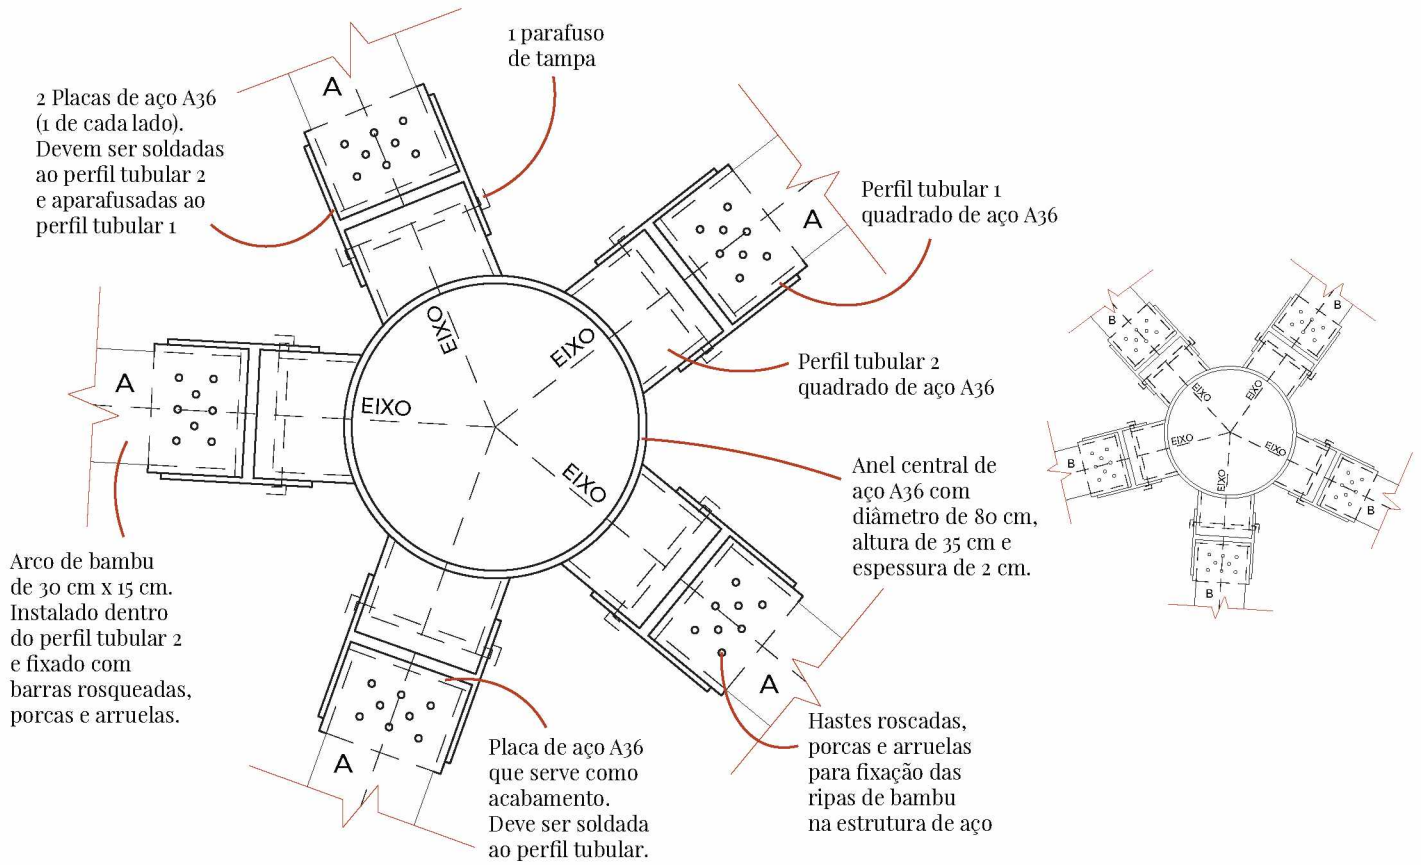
Detalhe Anel Estrutural - vista superior. Escala 1:20. Fonte: Elaborado pela autora.
